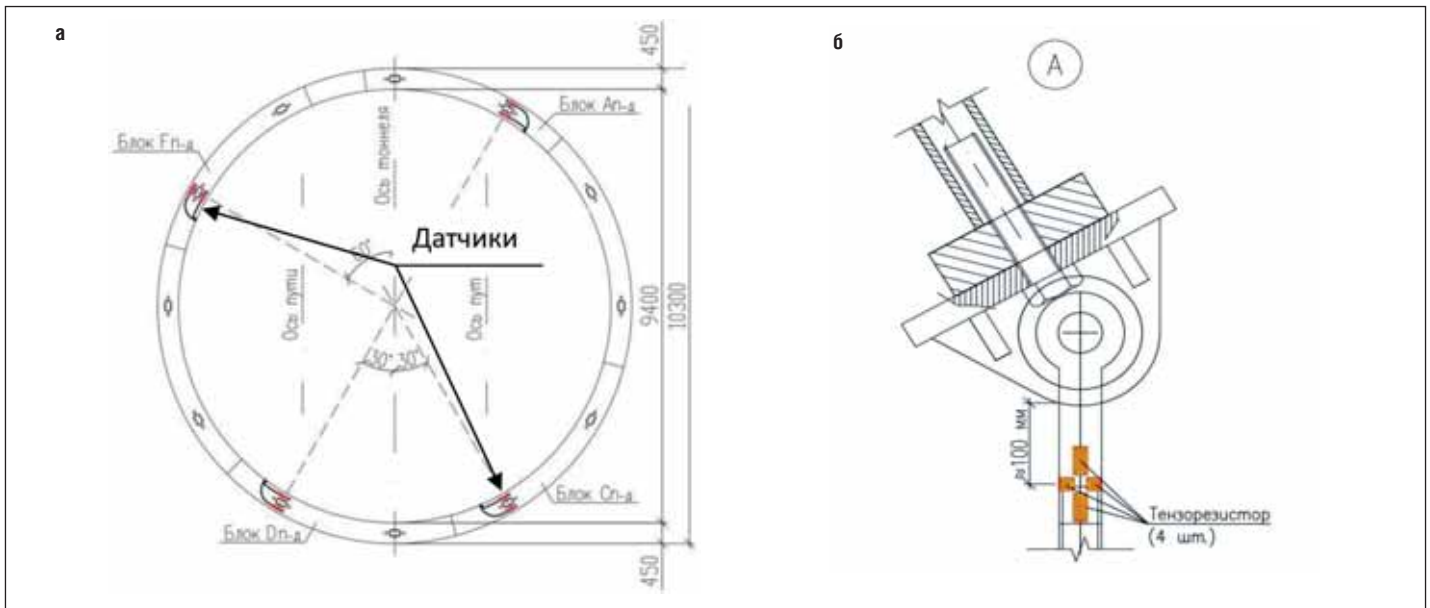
Схема размещения датчиков: а – в обделке двухпутного перегонного тоннеля; б – на тягах подвешного перекрытия
